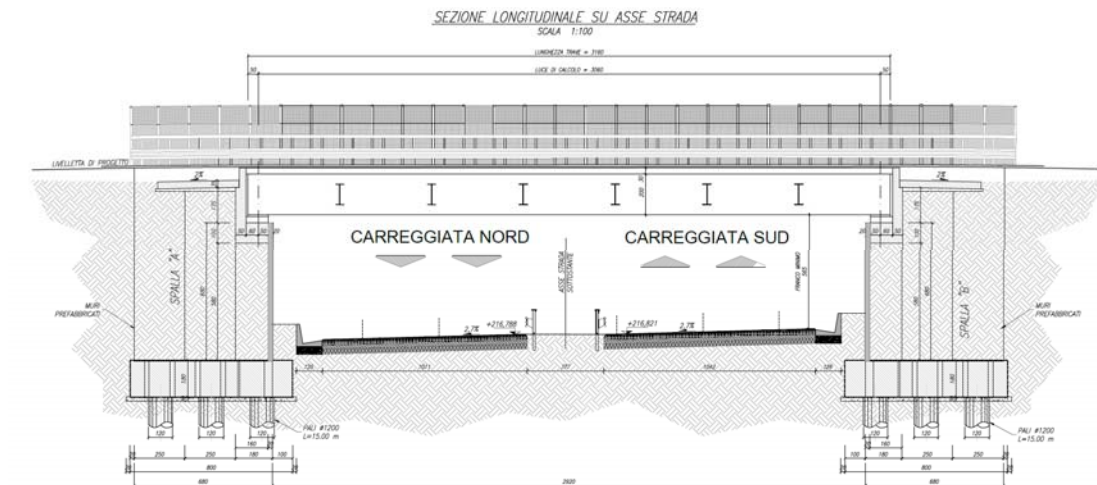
Cavalcavia al Km 3960: Sezione Longitudinale
